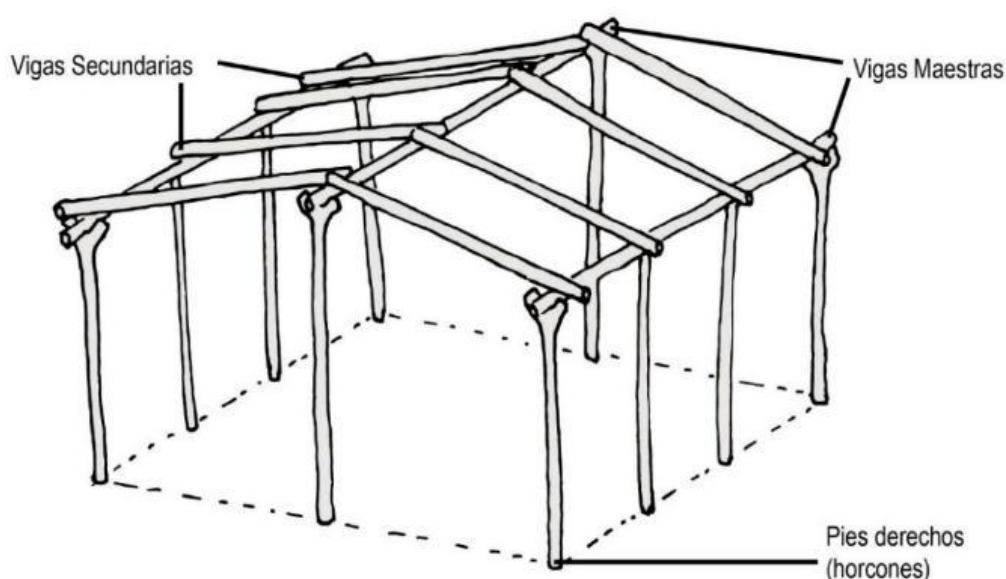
Estructura de madera en sistemas de entramado de la zona mixtas.
